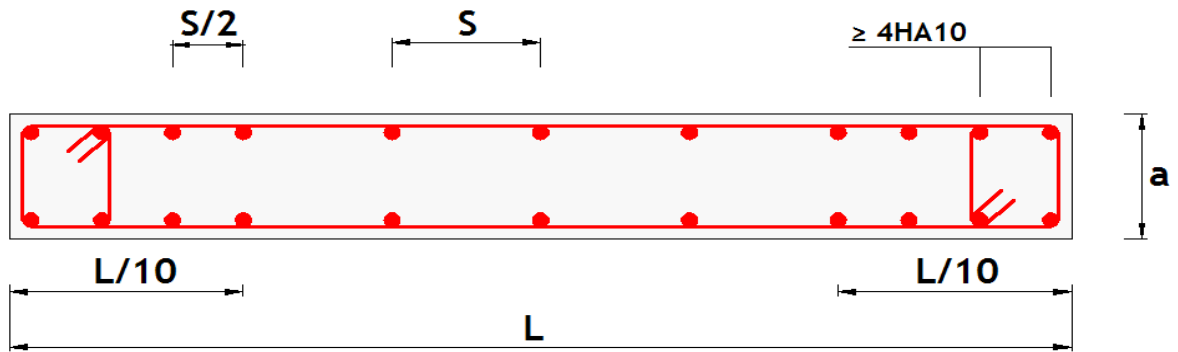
Disposition des armatures verticales dans les voiles.
